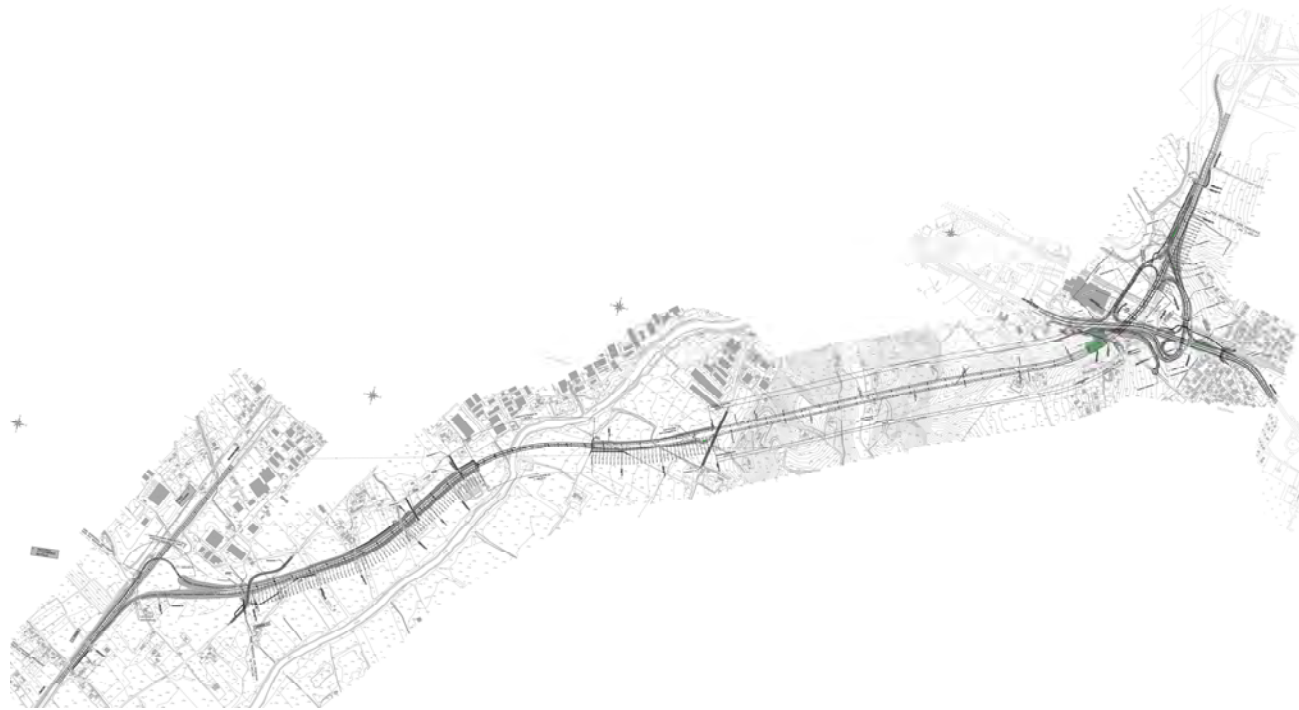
Planimetria sviluppo infrastruttura Tratto Madonna del Piano - Collestrada
